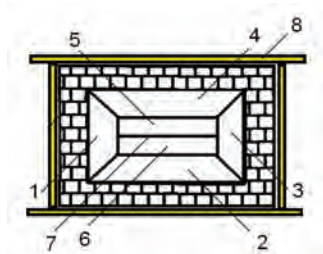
Схема предохранительной разрушающейся конструкции ограждения зданий.
